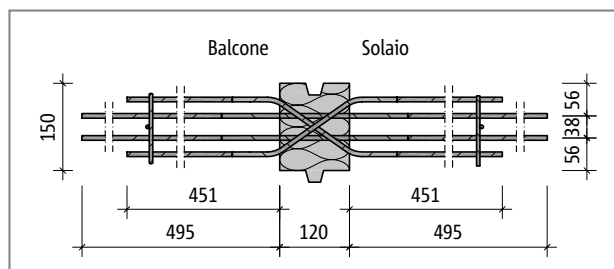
Schöck Isokorb® tipo EQXT1: pianta del prodotto
